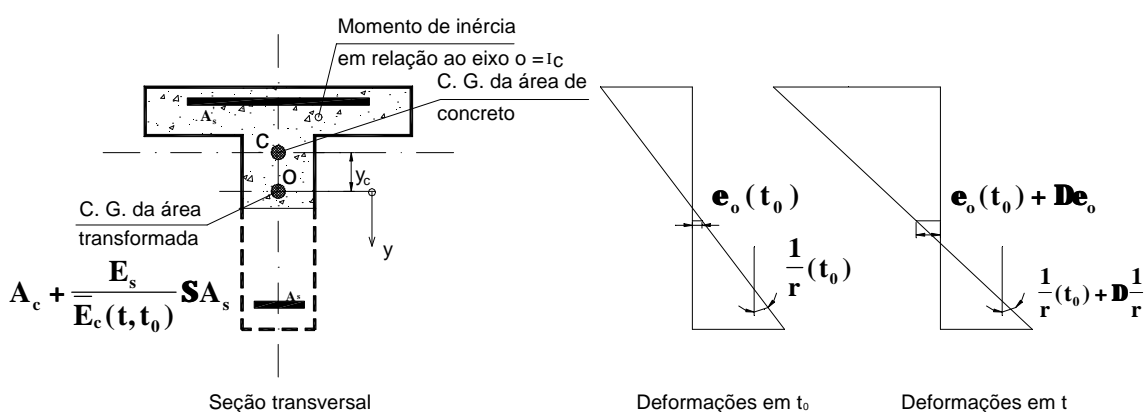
Efeitos da fluência e retração numa seção fissurada de concreto armado.
